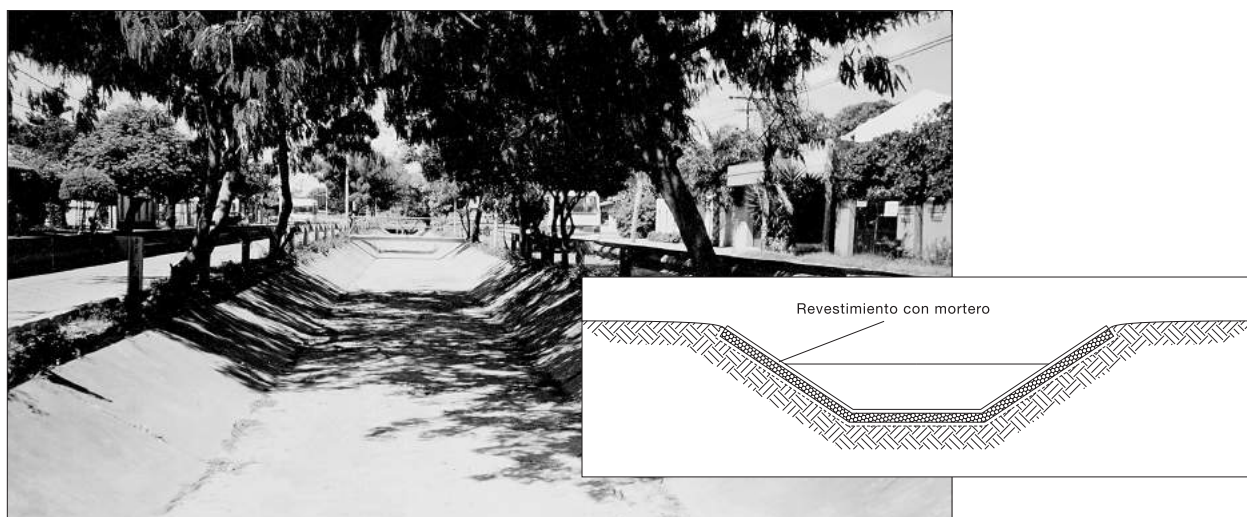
Avenida Beni - Santa Cruz - Bolivia.
